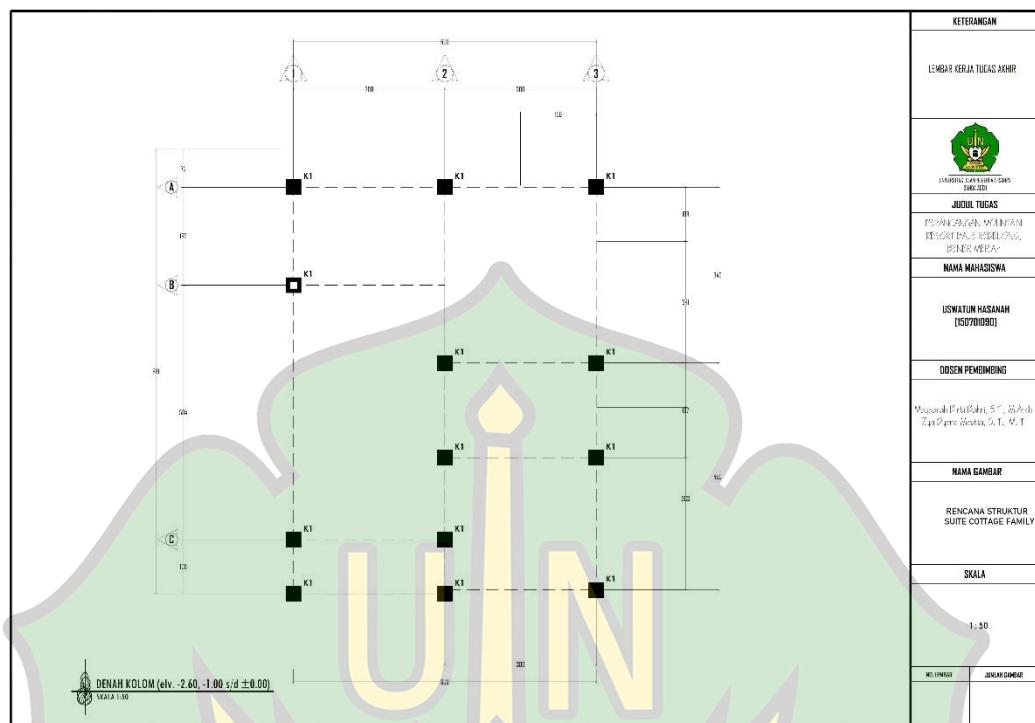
Rencana Kolom Suite Couple (Elv -2.60 - ±0.00)
